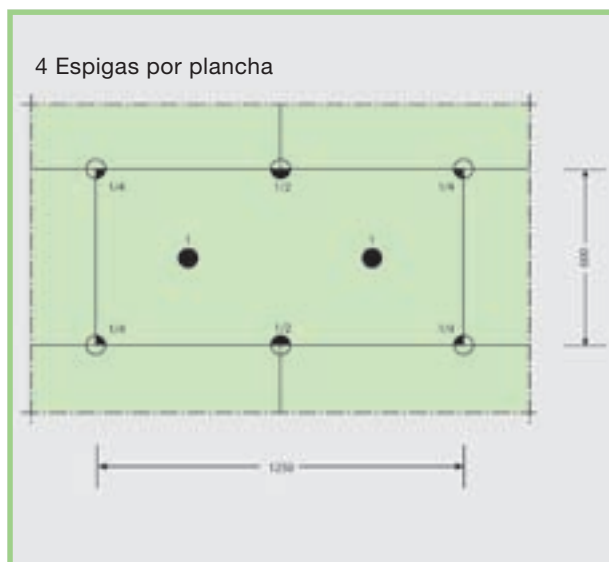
Número de espigas (4 por plancha) y distribución de espigas en fijaciones adicionales de planchas Styrodur® C en zócalos (medidas en mm).
